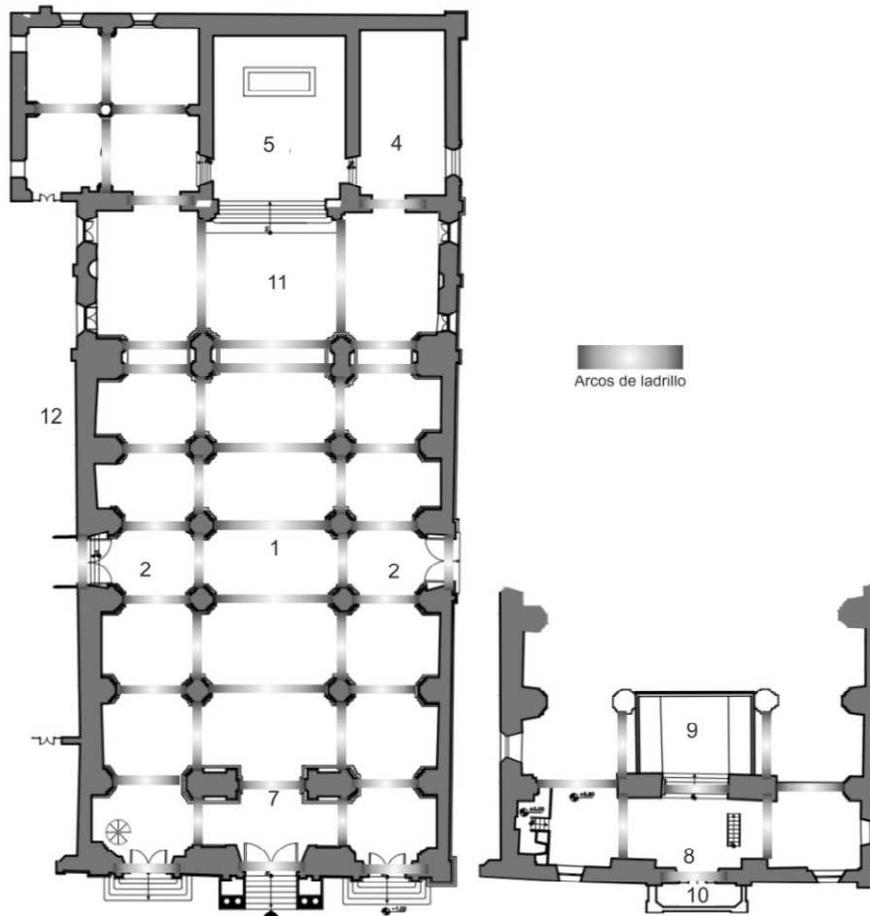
Ubicación del sistema de arcos estructurales del templo. 2016. Fuente: Planos del autor
